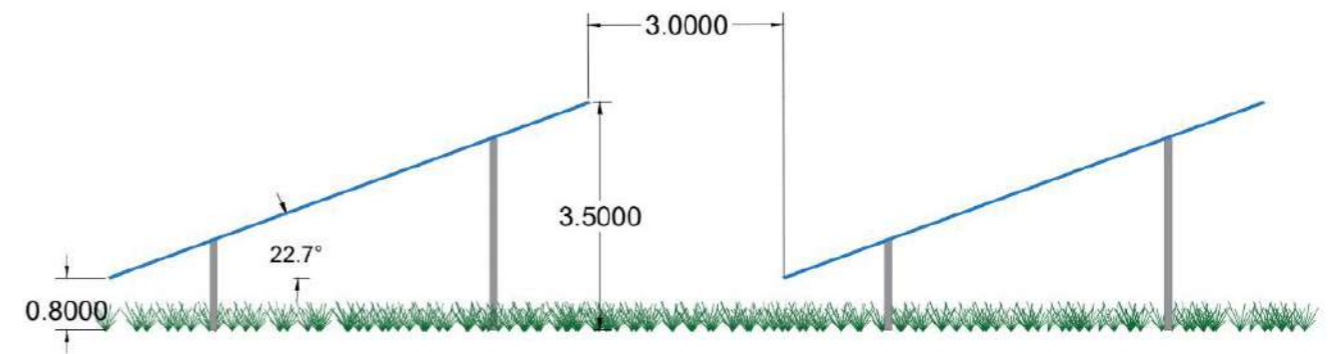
Plan de coupe des rangées de modules photovoltaïques (source : ENOE)
